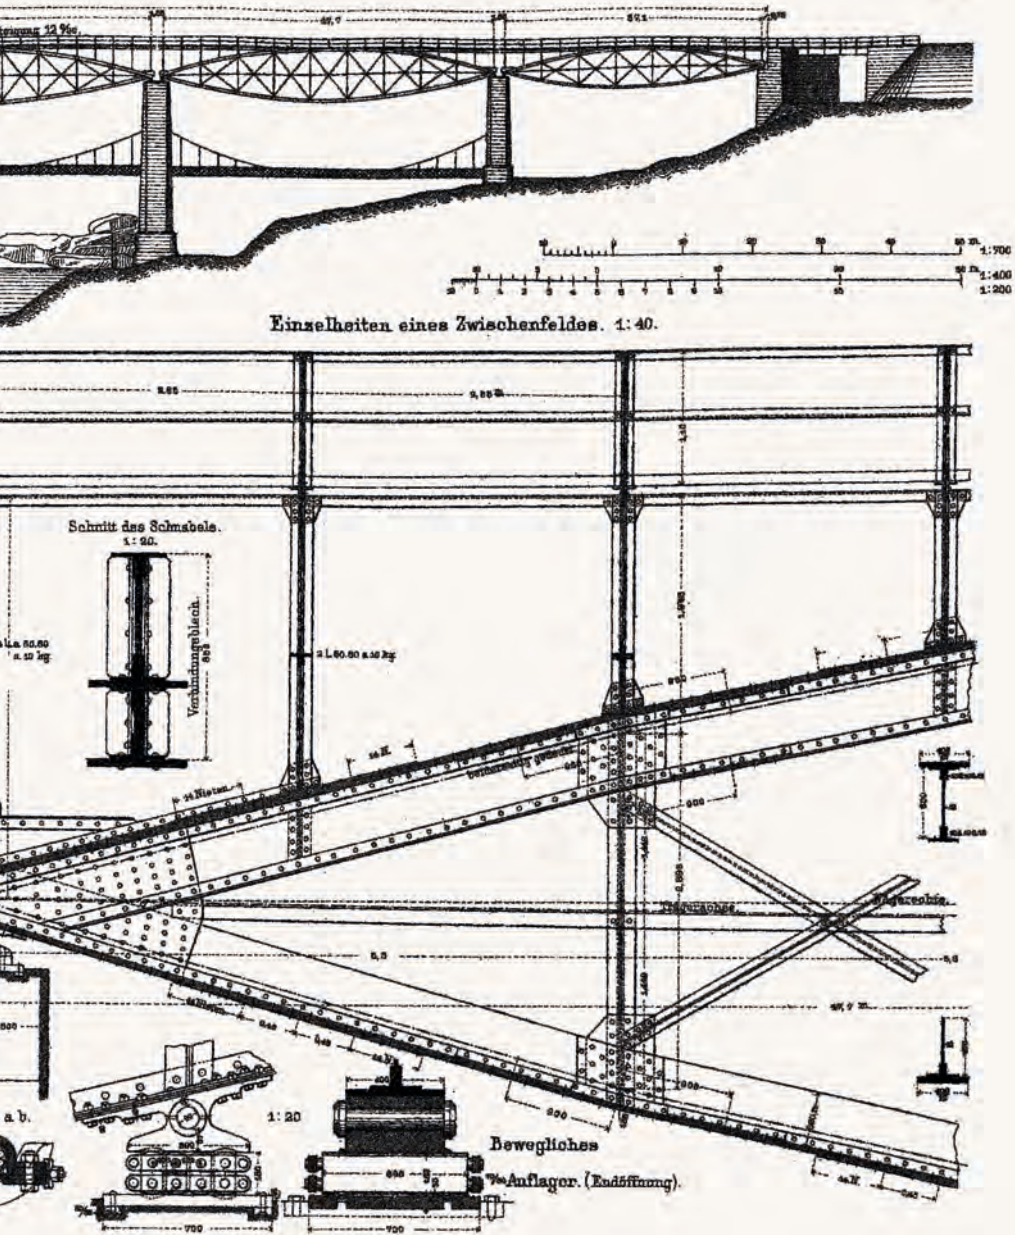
Plans du pont ferroviaire de Brugg (coord : 47.48328N, 8.19611E) sur l'Aar, construit en 1874-1875 (O. Riese, *Die Ingenieur Bauwerke der Schweiz*, 1887).
